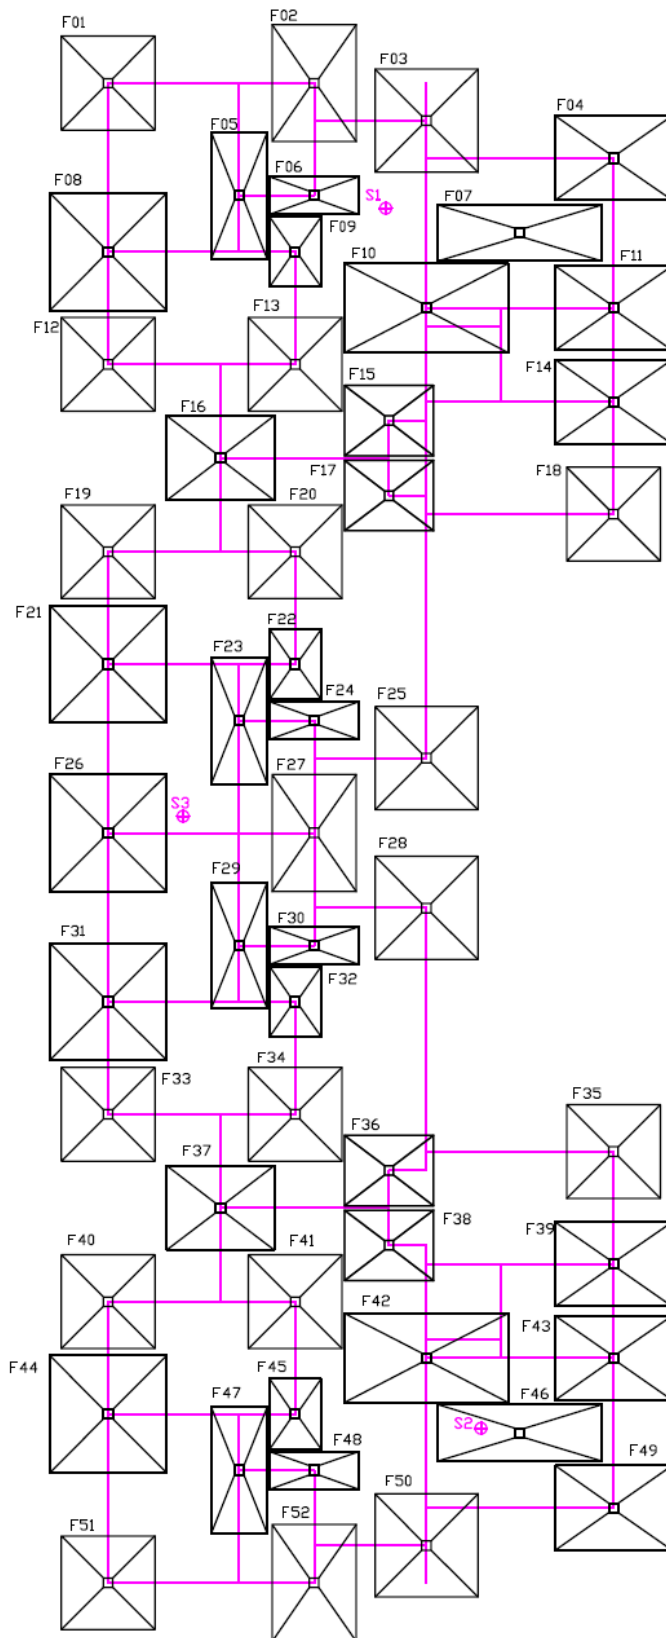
Planta de fundação rasa para o edifício alongado.
